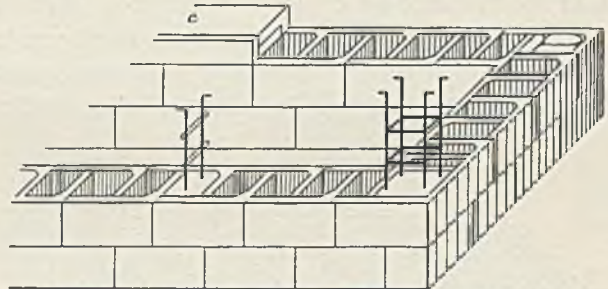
Mauer aus Hakensteinen mit Eisenbetonpfeilern und Deckenaufleger (c).
